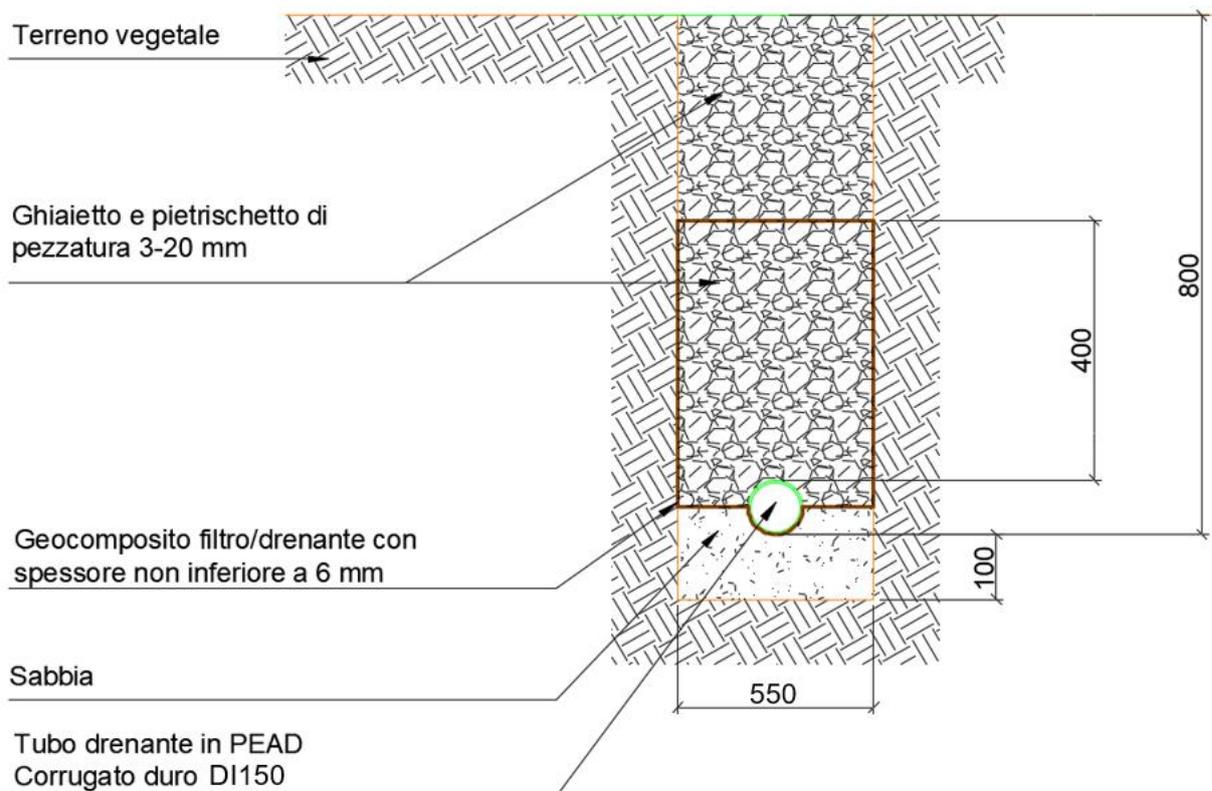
Sezione trincea drenante con tubazione DI 150 e riempimento dello scavo con ghiaietto e pietrisco di pezzatura 3-20 mm
